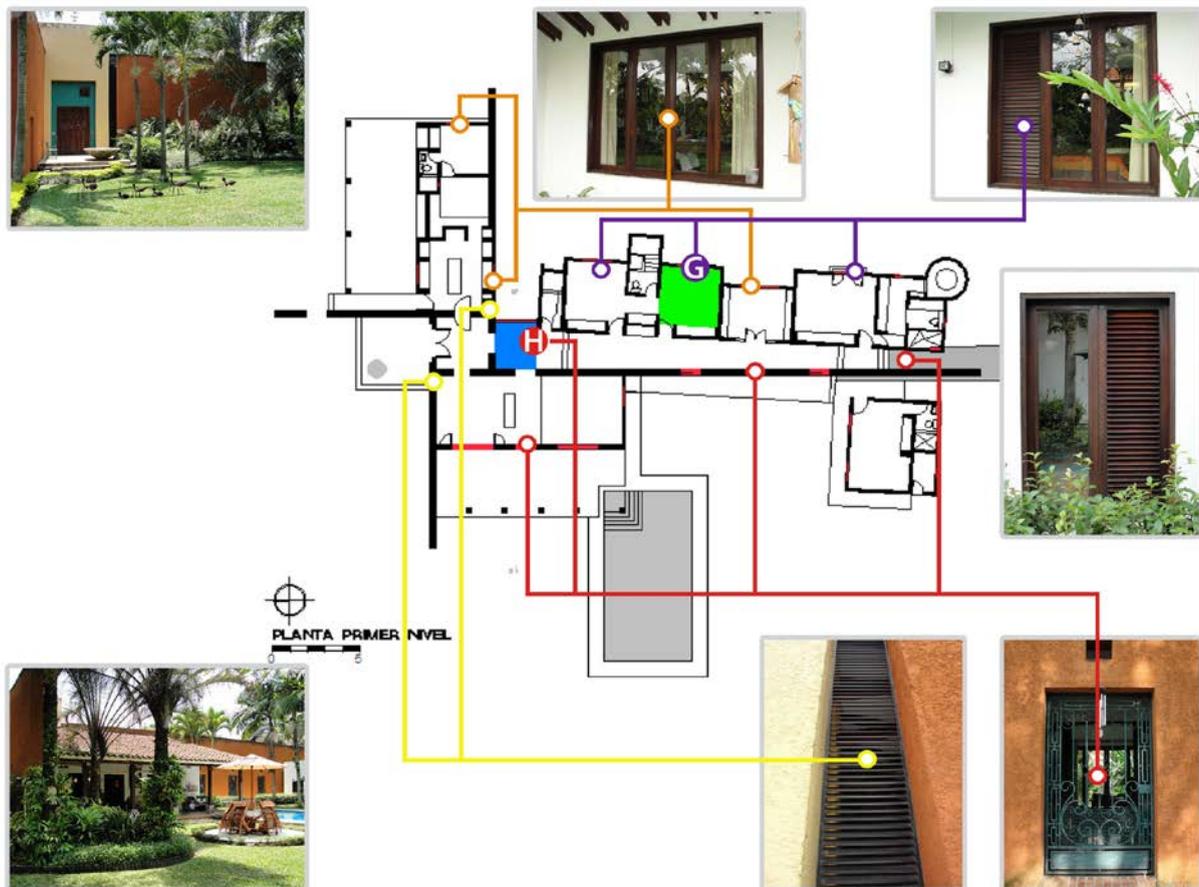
Planta general y fotografías “La Rebeca”. Fuente: Planos y fotos María Clara Betancourt (2010)
